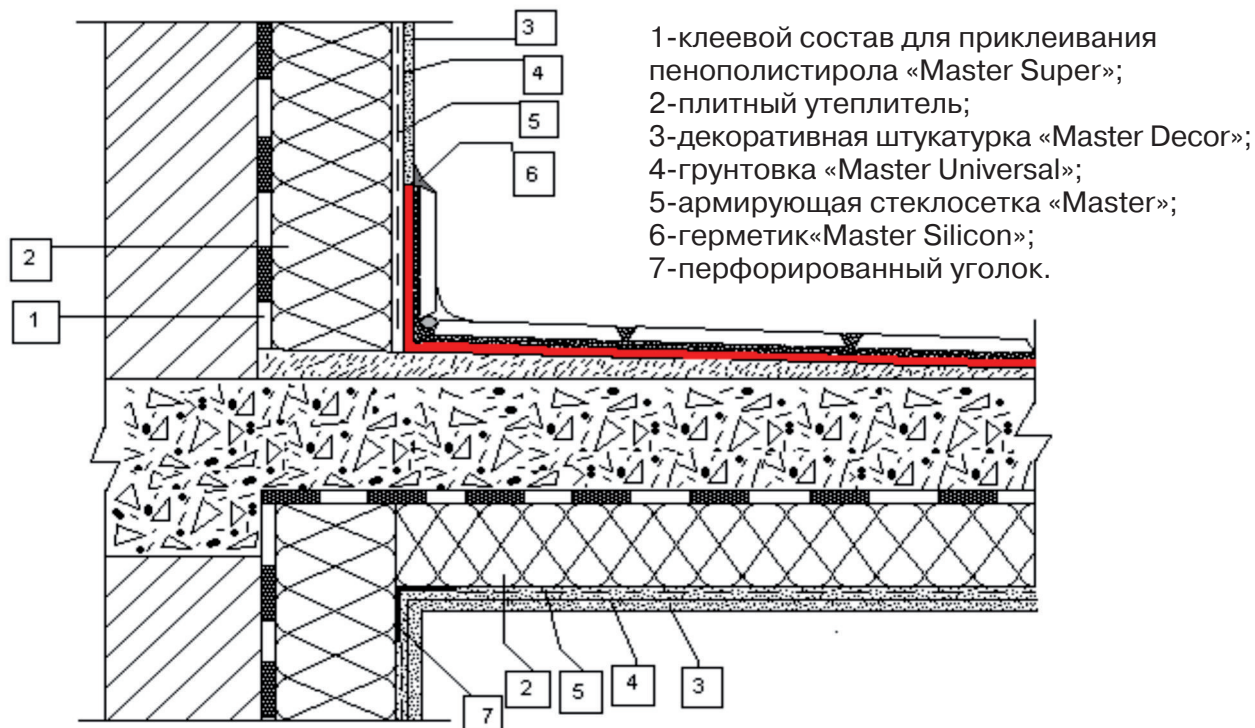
Фрагмент обустройства теплоизоляции балкона
